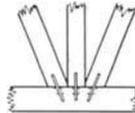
Druckstoß mit kleinen Zapfen und Bauklammern.
